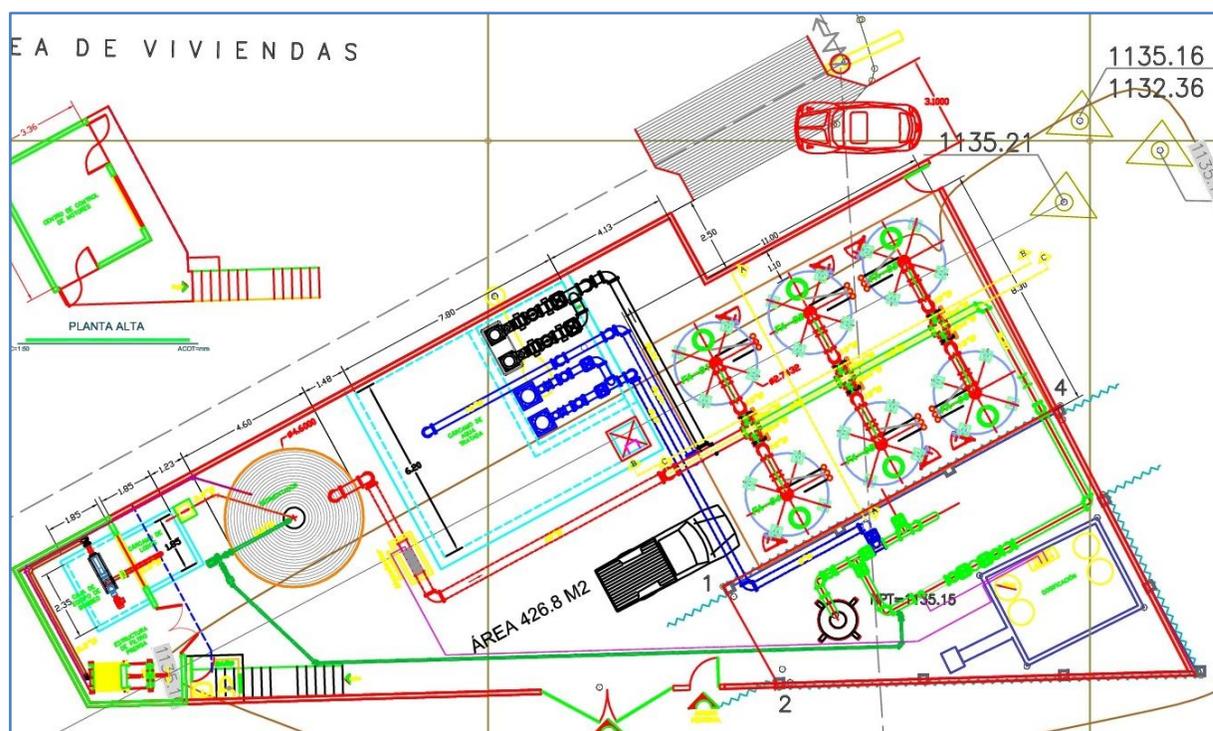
Propuesta inicial de arreglo general de equipo planta pozo 24-A
